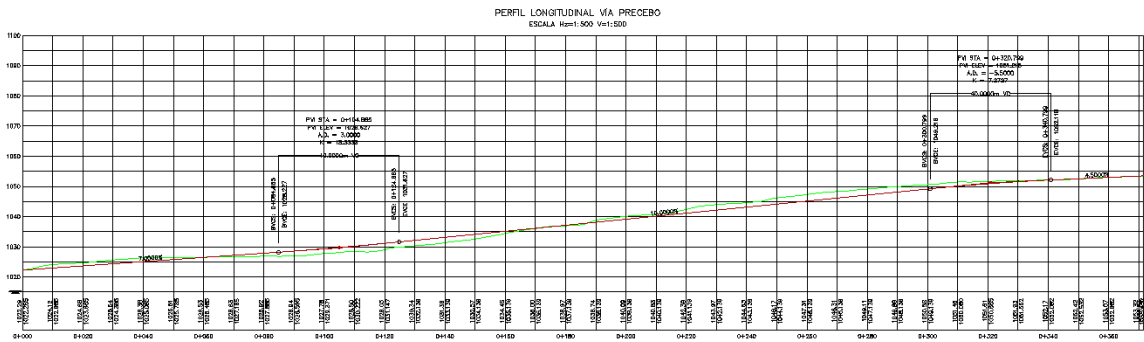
Perfil longitudinal de la nueva vía proyectada.
